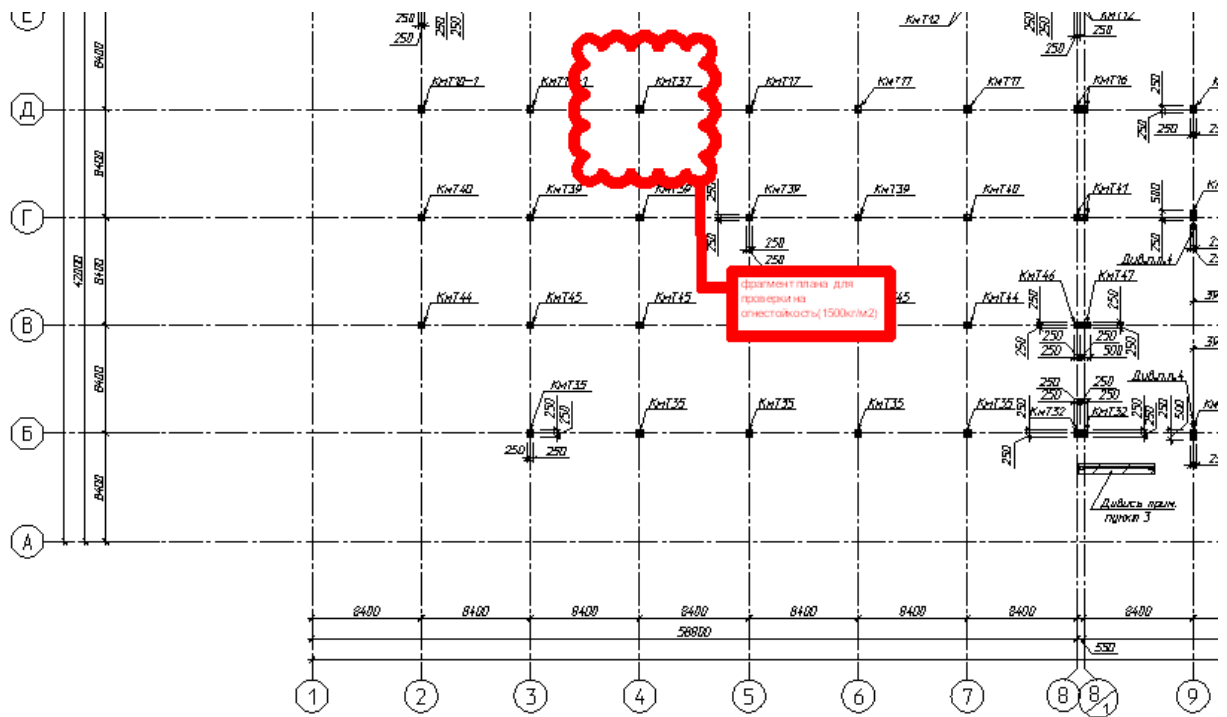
Розташування фрагменту будівлі нижнього ярусу
